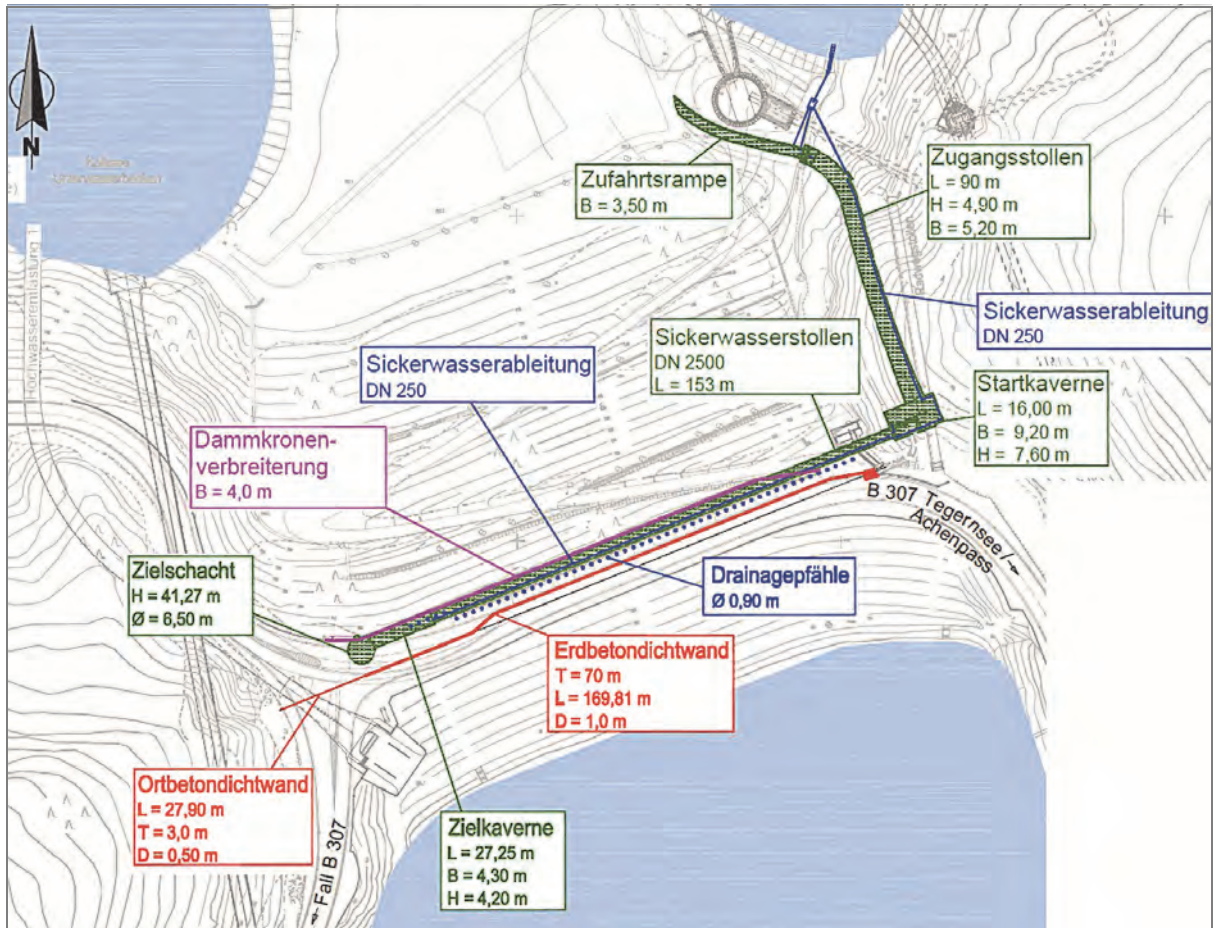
Grundriss des Dammes mit den neu geplanten Anlagenteilen.
